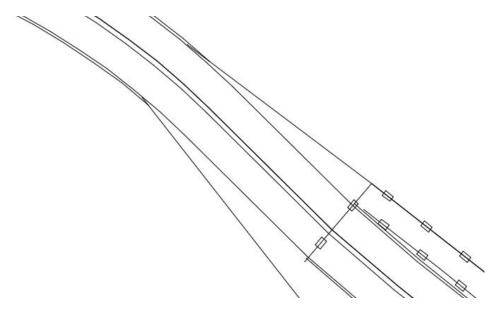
Detalle trazado túnel. Fuente: AutoCAD
